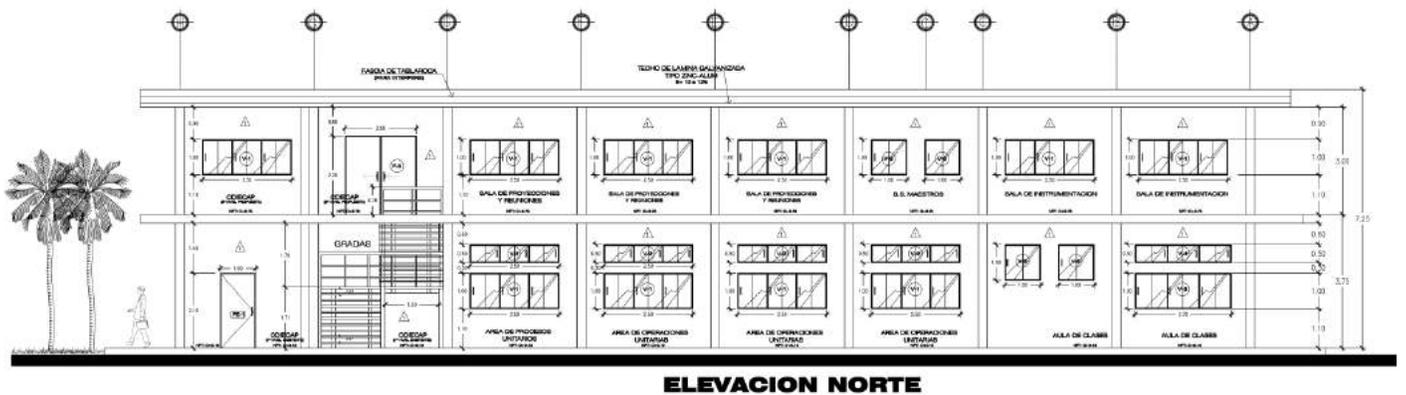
Elevación Norte - “Ampliación y Remodelación del laboratorio de Ingeniería Química y Alimentos” elaborada por: Arqta. Victoria Hernández Abrego. Fuente: Hoja A -2/4 de los planos constructivos del archivo proporcionado por Ing. Tania Torres como parte de la documentación antecedente del tema.
